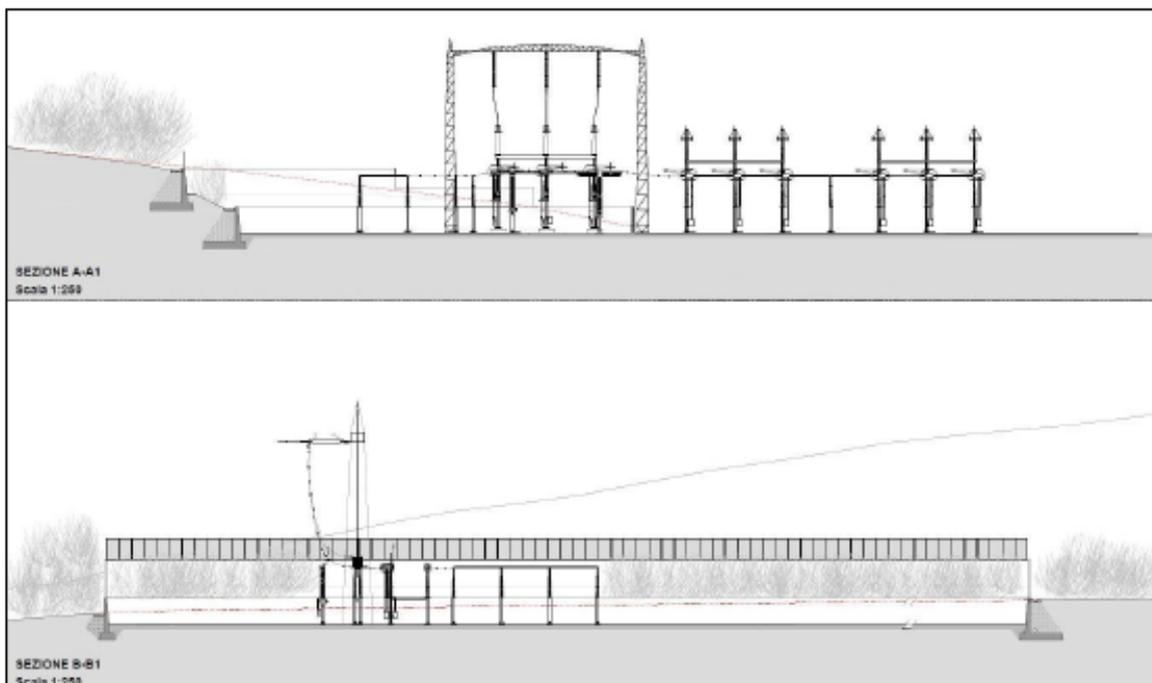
Opere di connessione alla Stazione TERNA: sezioni dello stallo 380 kv
